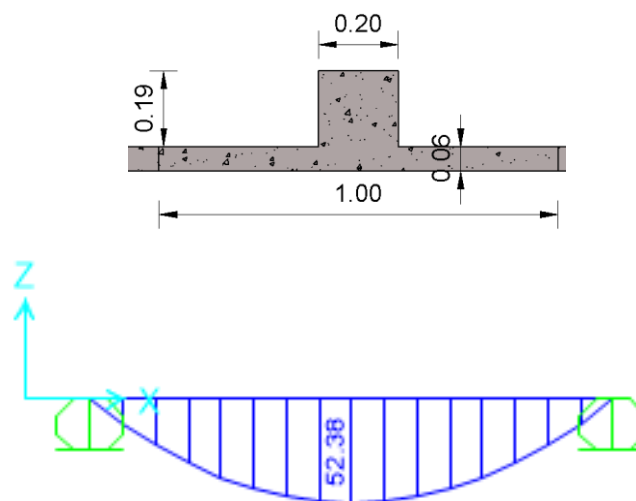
Sección geométrica (superior) y esfuerzos de flexión (inferior) en prelosa autoportante Fase 1
